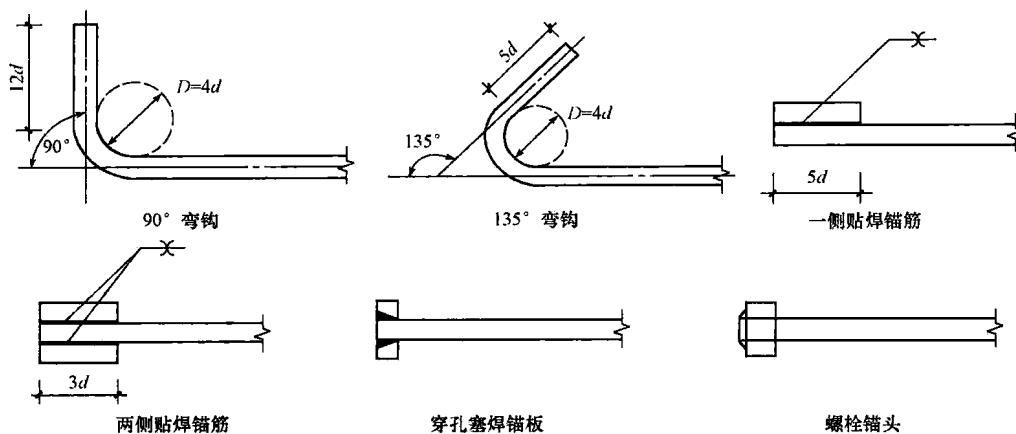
钢筋弯钩和机械锚固的形式和技术要求
